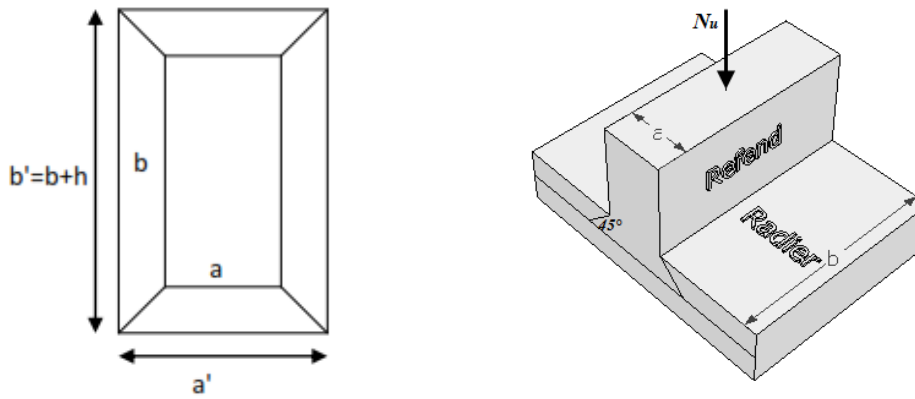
Périmètre utile des voiles et des poteaux.
